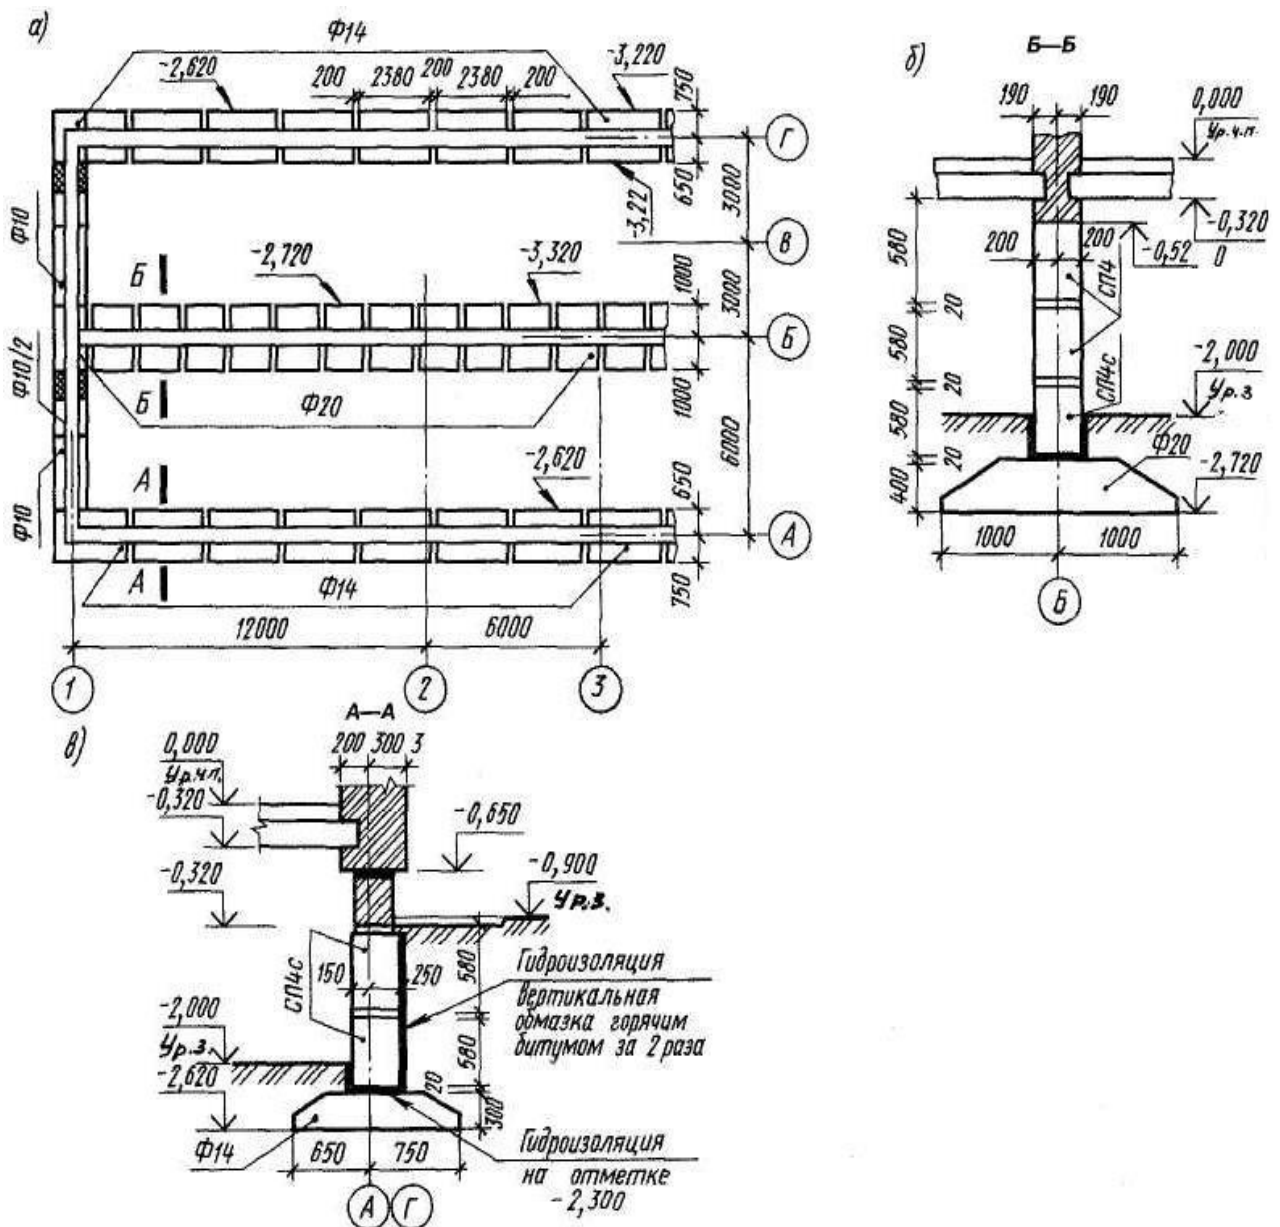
Схема расположения элементов фундамента (а), сечение фундаментов по внутренней (б) и наружной стене (в)
